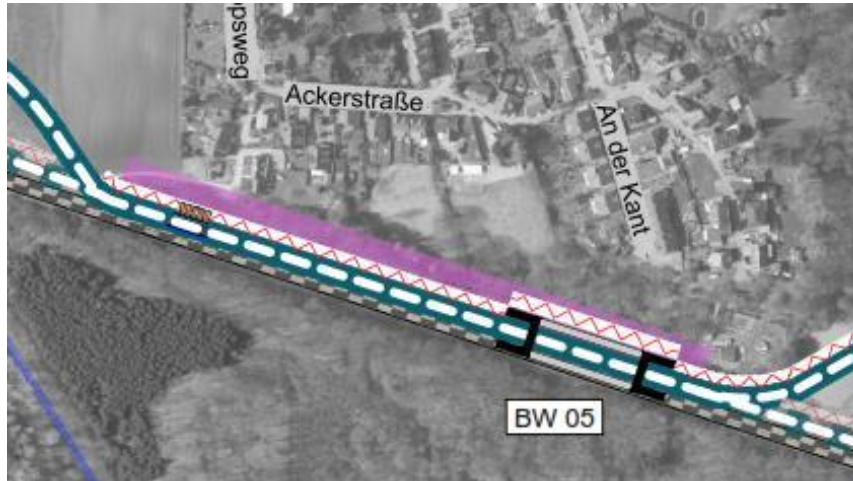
Lage BW 05 – Überführung Senke Pesch
